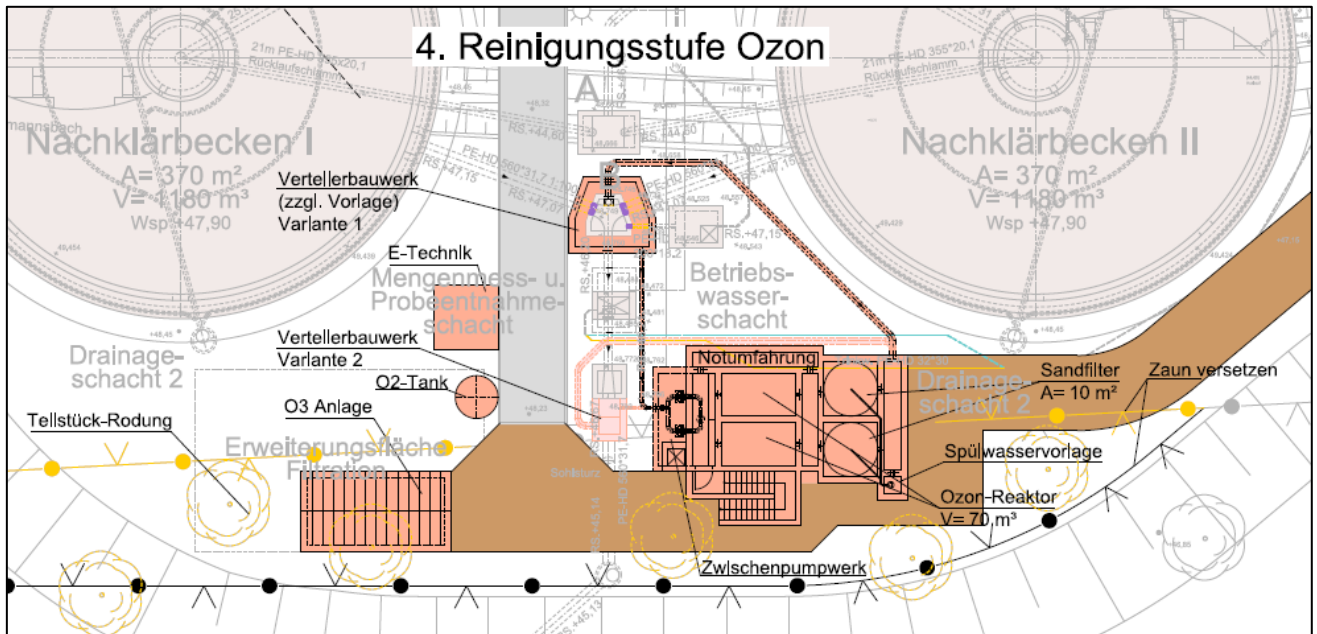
Lageplanausschnitt Variante 1: Ozonung mit nachgeschaltetem Dynasandfilter
